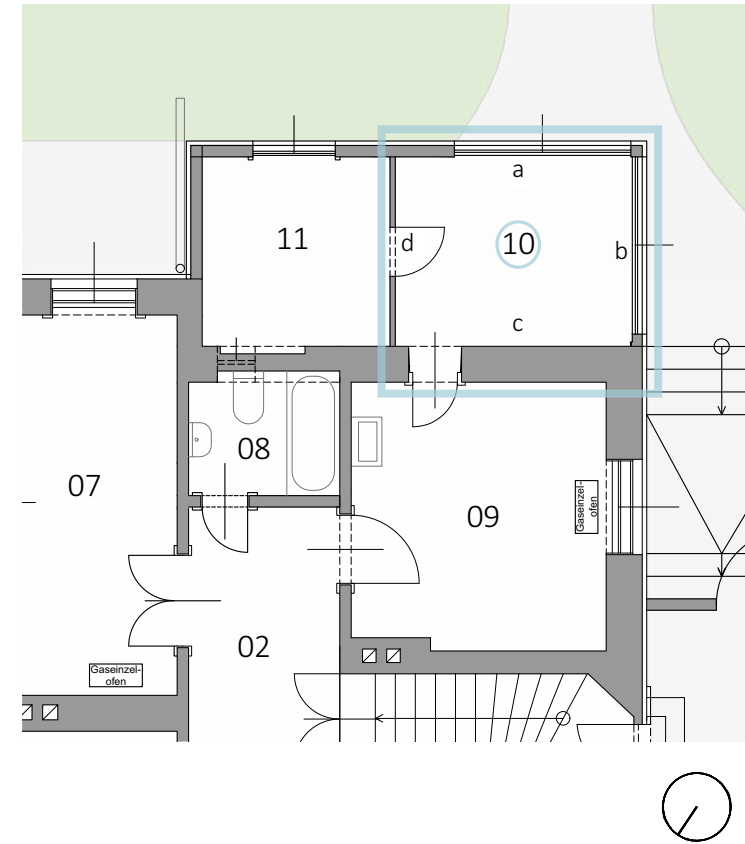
Grundriss OG 10 Veranda 1, M=1:100.
